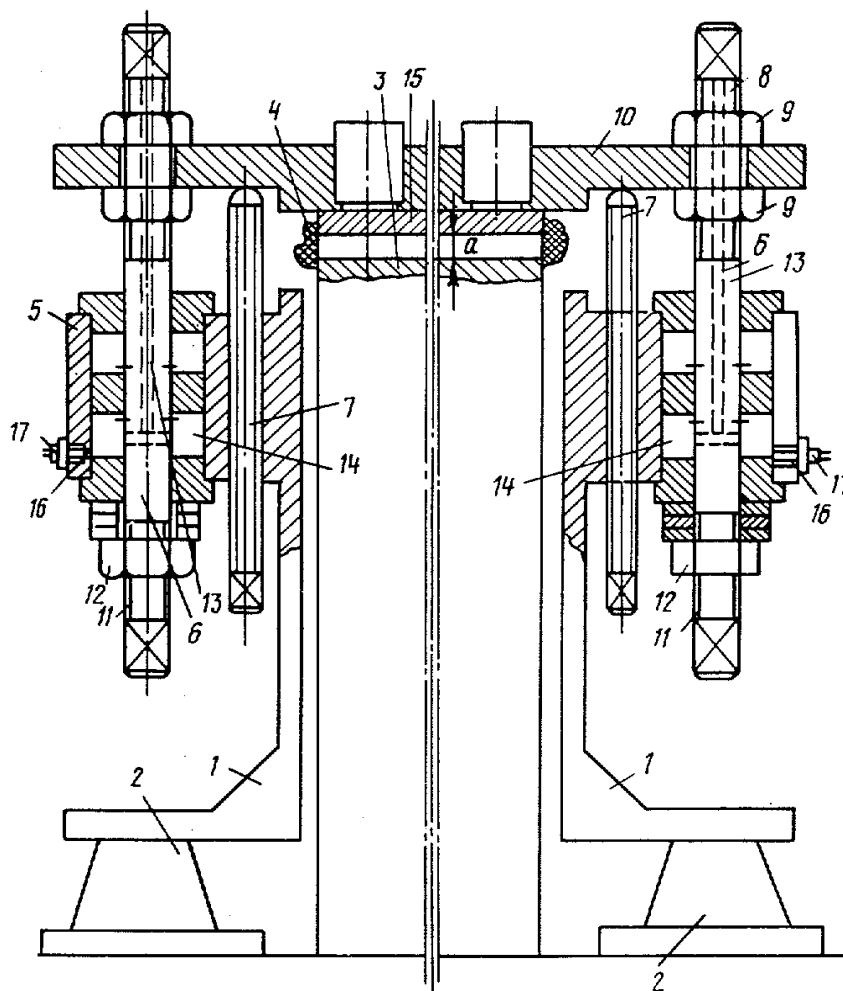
Схема устройства для восстановления деталей механо-сборочного оборудования
